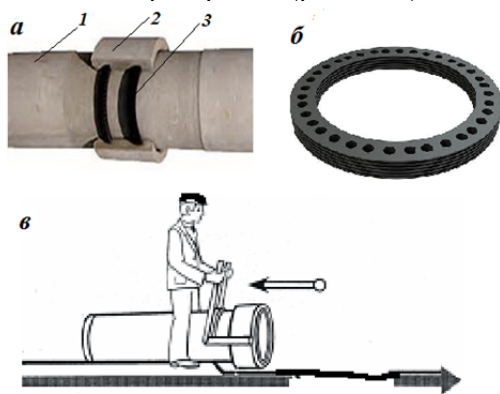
Монтаж азбестоцементного трубопроводу
